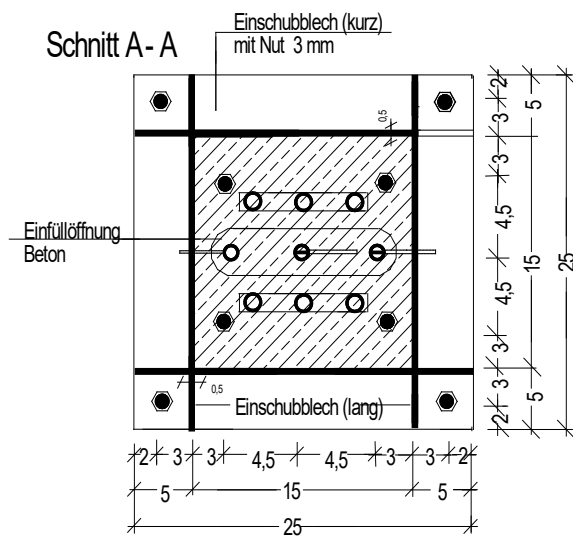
(H) - Prüfarm 3 Einkornbetonzylinder
